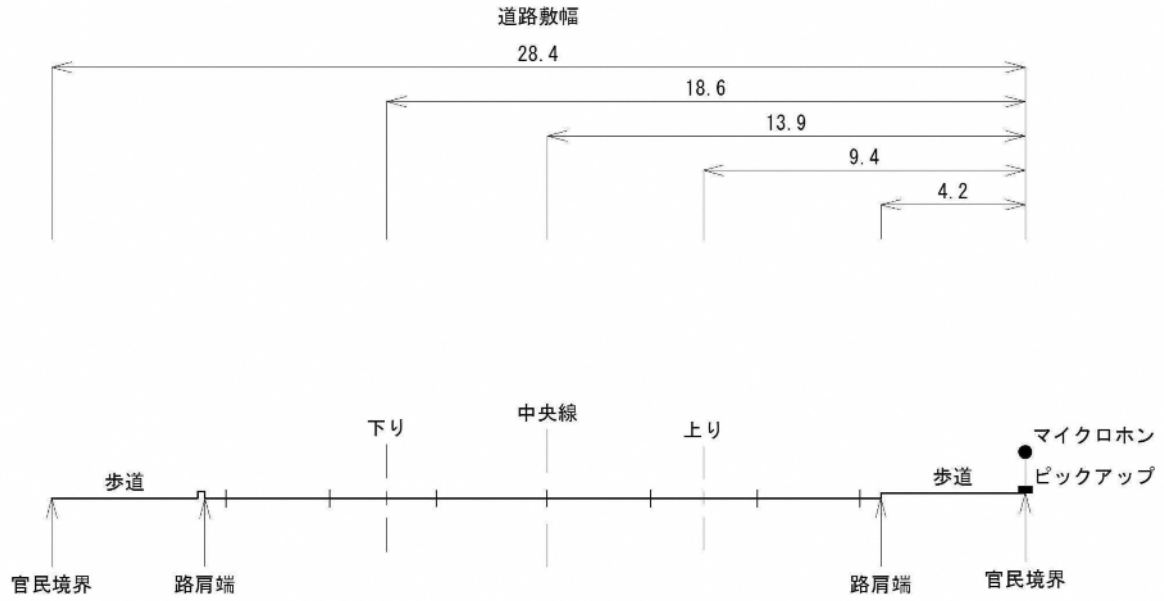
(1) 調査地点道路断面図(単位 : m)
